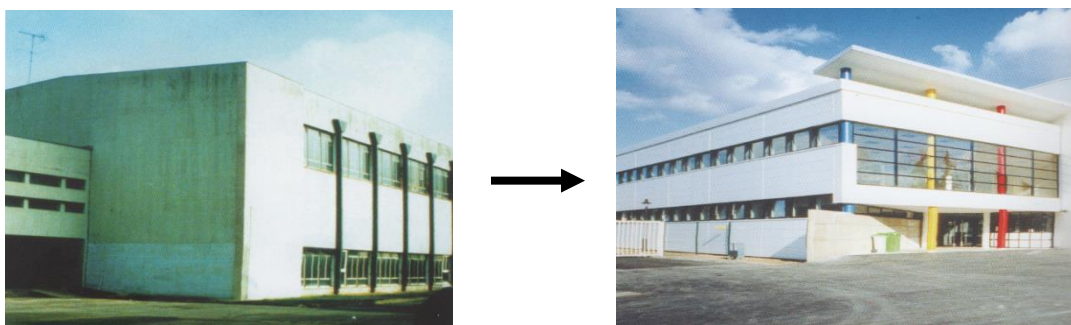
Pose d'une peau isolante en panneaux sandwichs sur un mur en béton du Lycée Paul Valéry.
